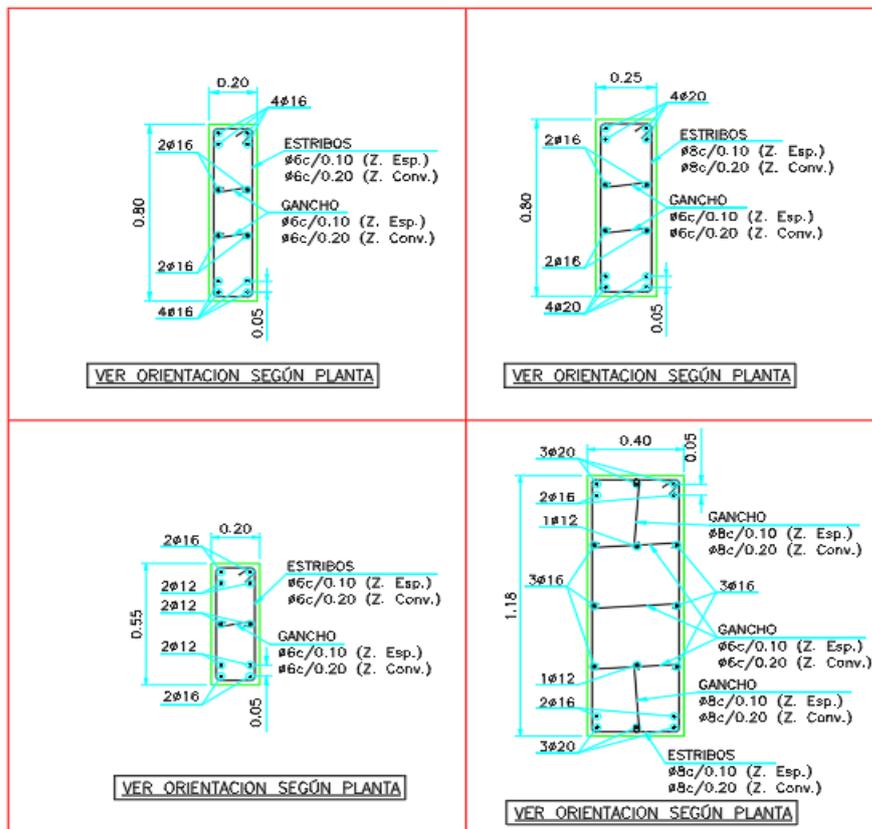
Detalle de columnas de 1SS y 2SS
